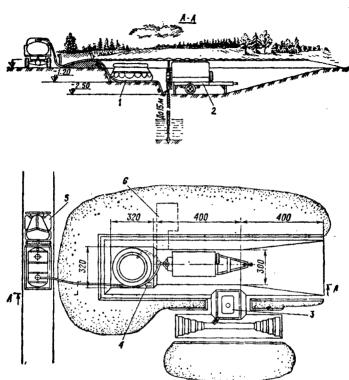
Пункт водоснабжения на установке для добычи грунтовых вод УДВ-15 (вариант):
